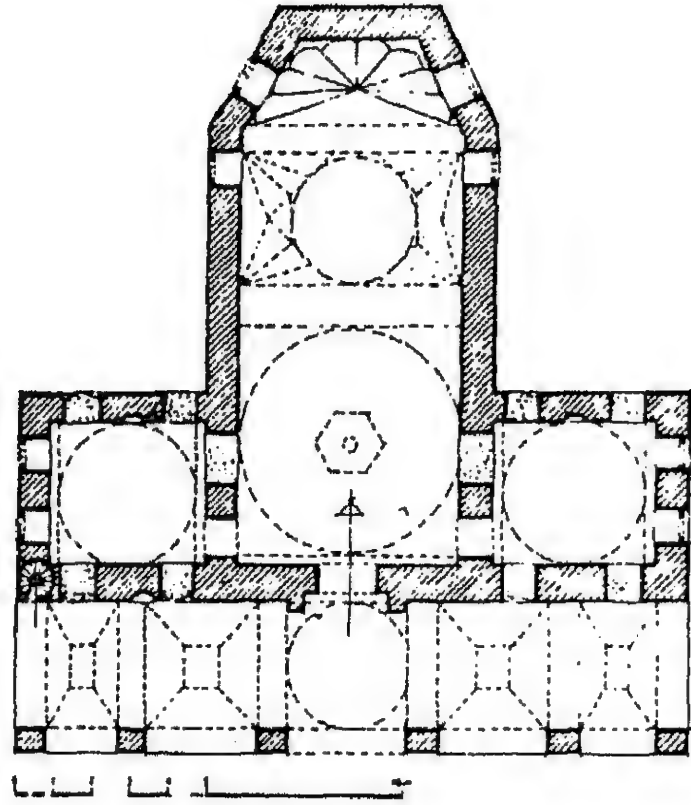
مسقط أفقي لمسجد فاتح باشا بد يار بكر (عن : اصلان ابا)
